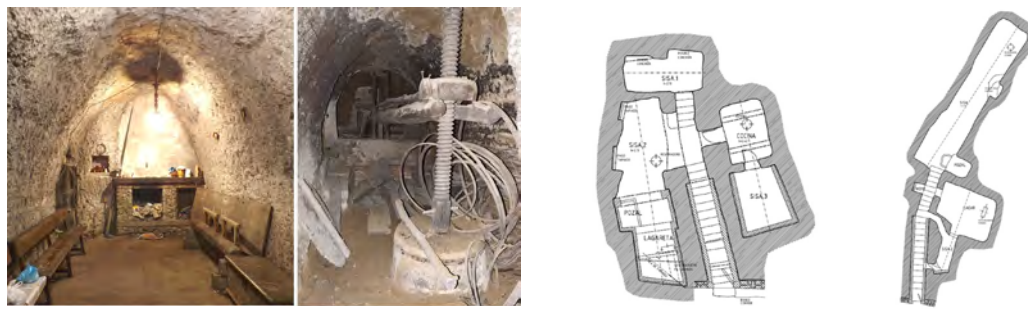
Arriba, vista de nave y lagar en Villamuriel. Fuente: elaboración propia del autor (2014). Abajo, planta de bodega de naves paralelas y planta de bodega de naves longitudinales. Fuente: Catálogo del Plan Especial de Bodegas de Baltanás.
